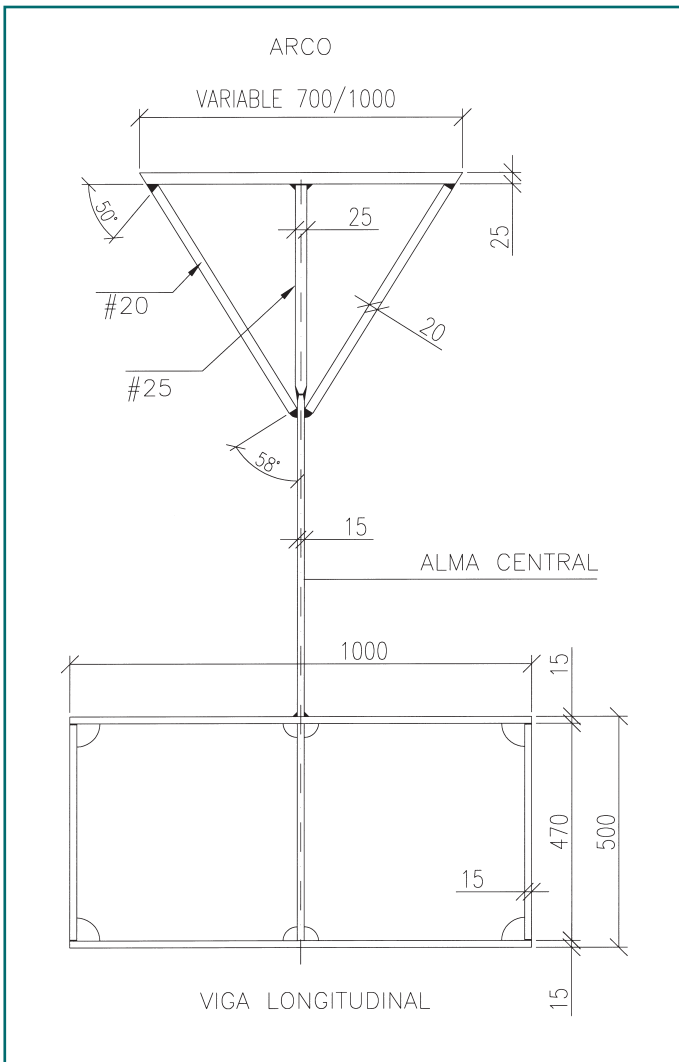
Sección transversal del arco y la viga longitudinal/Cross section of the arch and longitudinal beam.
